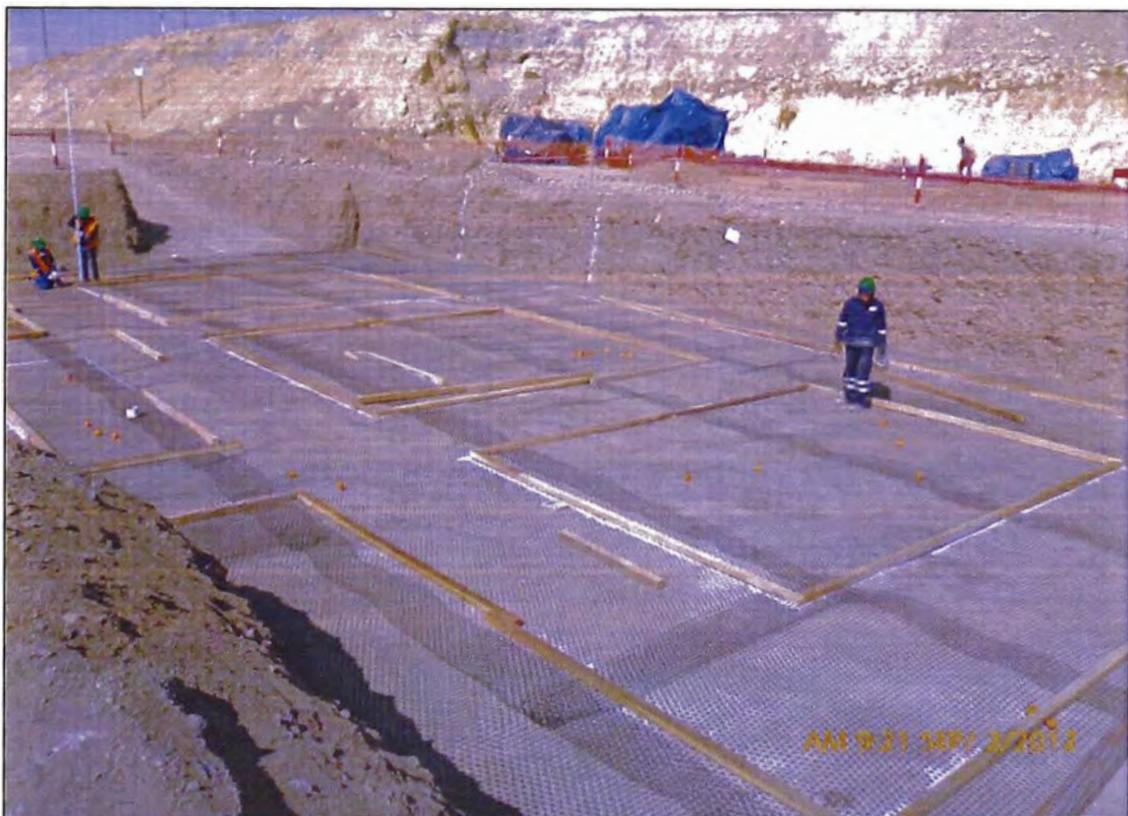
Encofrado de perímetro de solado para zapatas.
